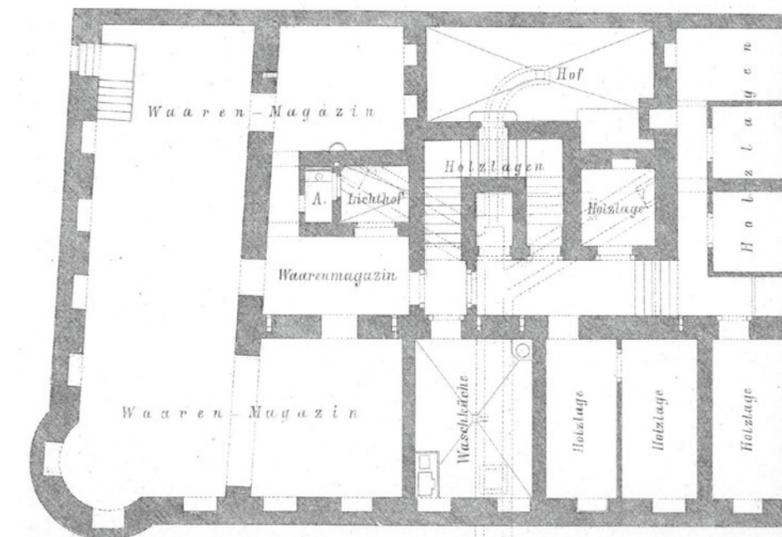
Schwindgasse 20 – publizierte Pläne 1885, Einreichplan 1883 (Lageplan)
